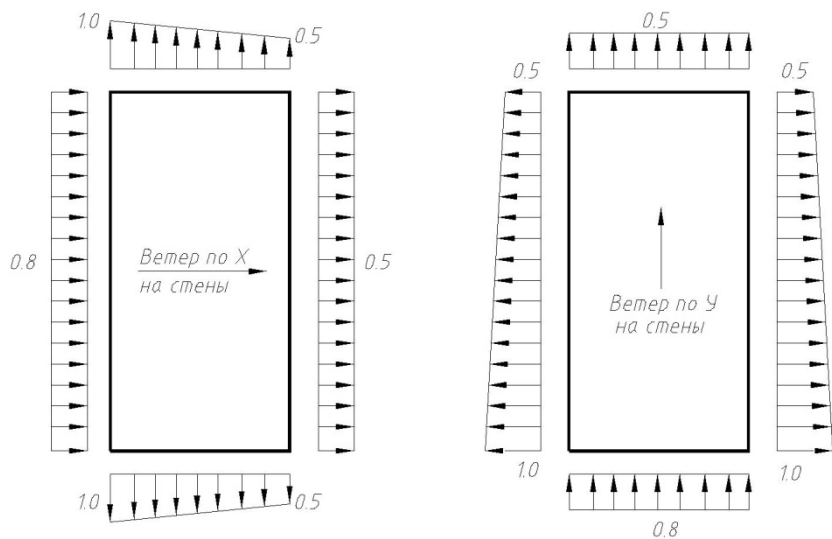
Схема приложения ветровой нагрузки на стены
